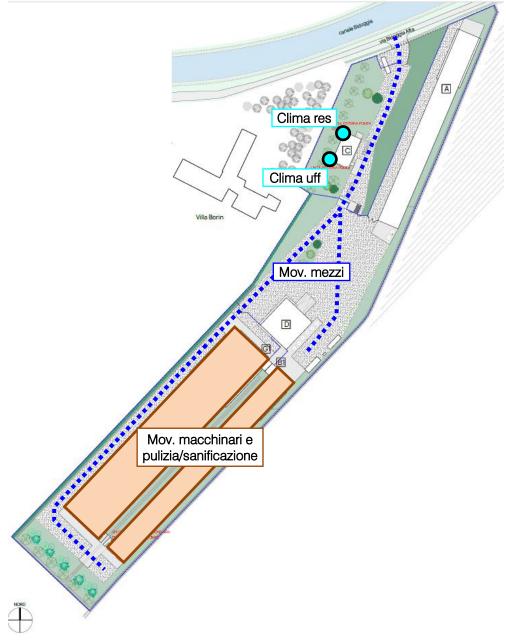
Planimetria dell'allevamento nella configurazione di progetto con individuazione sorgenti sonore attività di pulizia.
